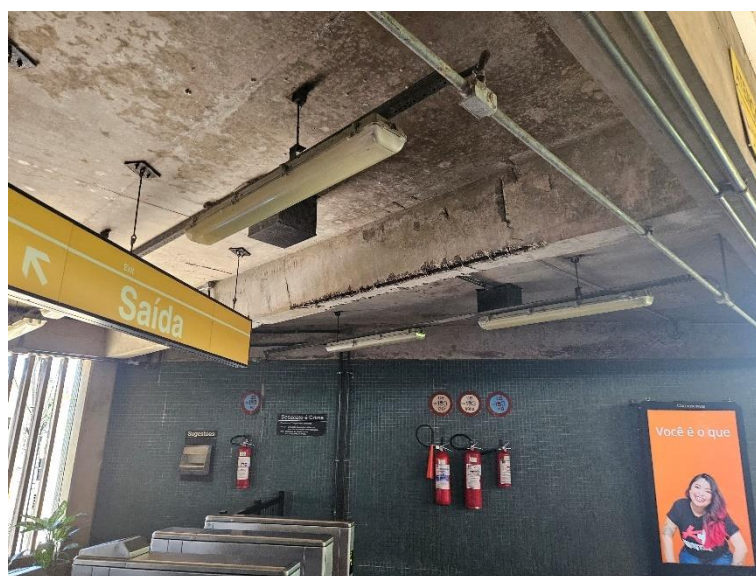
Infiltrações e Ferragens expostas na laje e viga do saguão
